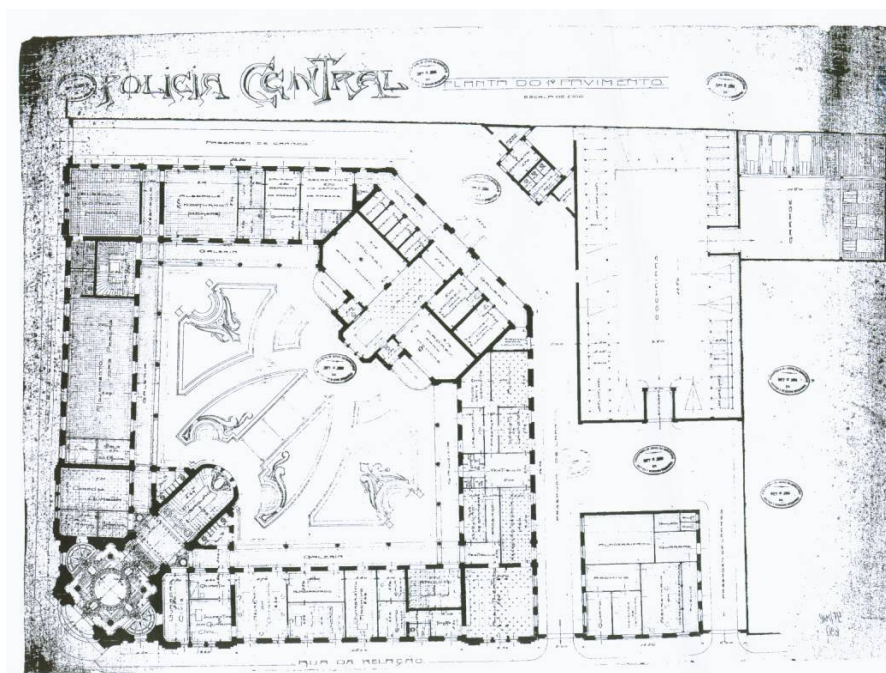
Planta baixa DOPS - 1º pavimento. Fonte: IN CUNHA, 2002 Fonte Original: Arquivo Nacional.
